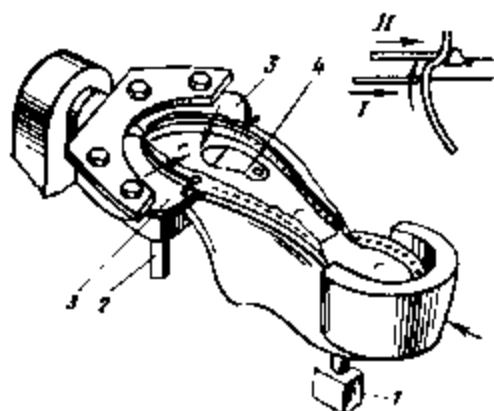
Схема затяжки носочной части заготовки пластинами
